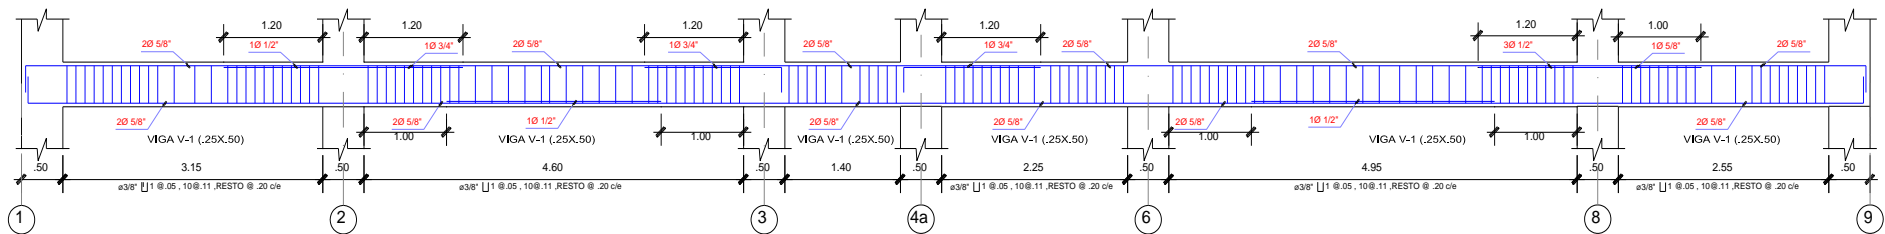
Detalle del Refuerzo en la viga del eje E (V25X50)
